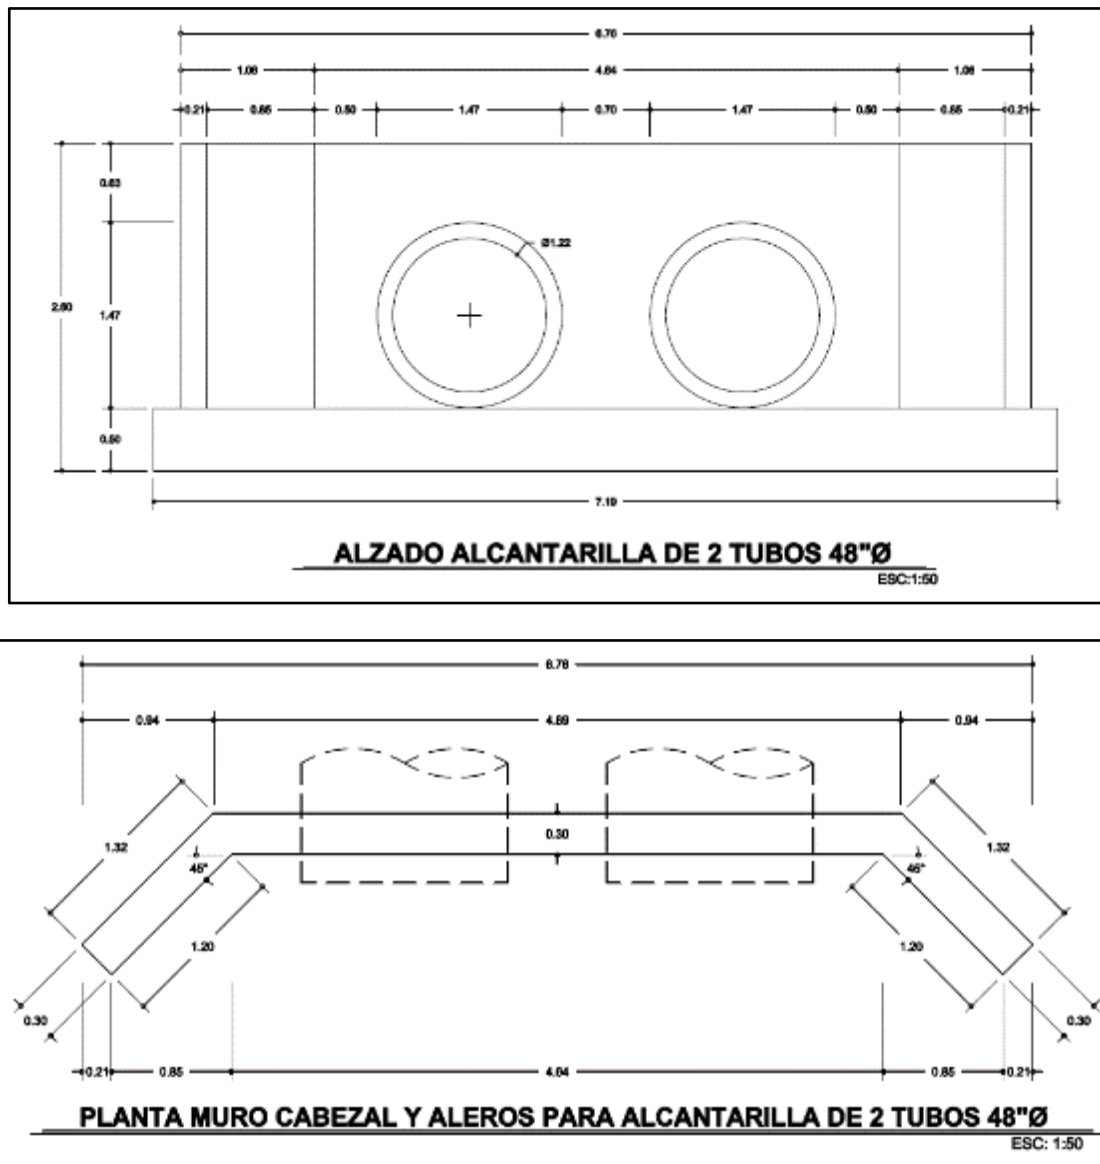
Dimensiones de construcción de obra de drenaje para el camino de acceso del pozo Kinkan-1EXP.
